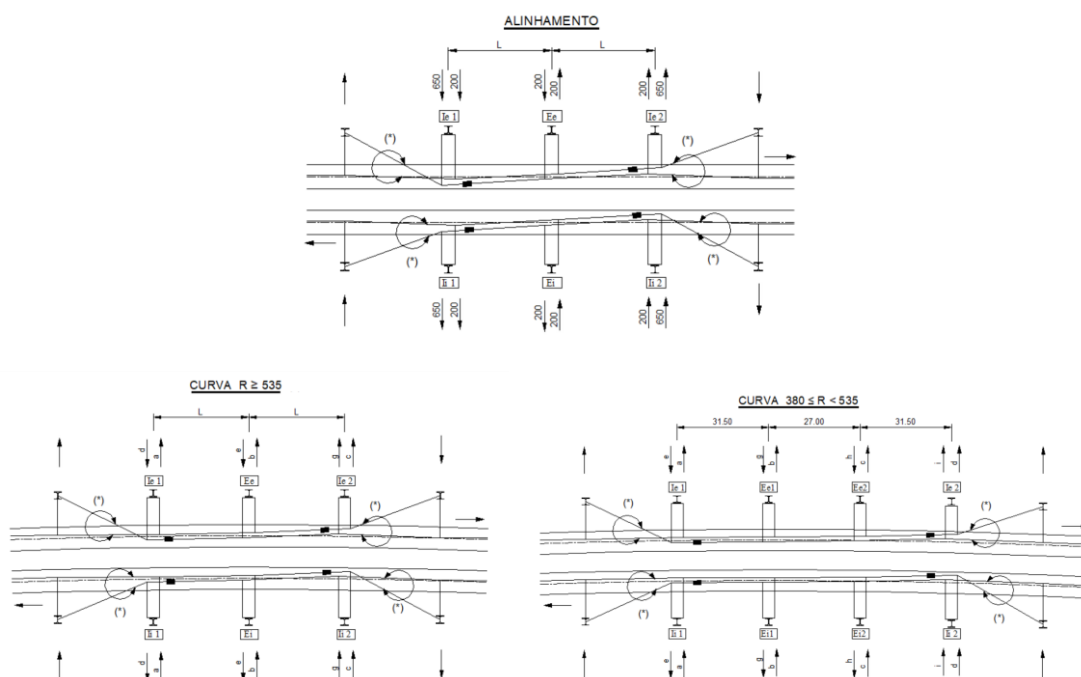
Seccionamento de lâmina de ar – piquetagem em alinhamento reto
